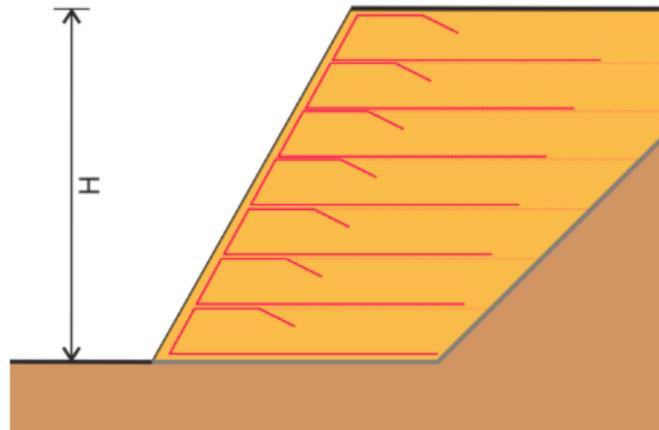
Querschnitt einer bewehrten Erde - Konstruktion (ÖGG, 2018)
